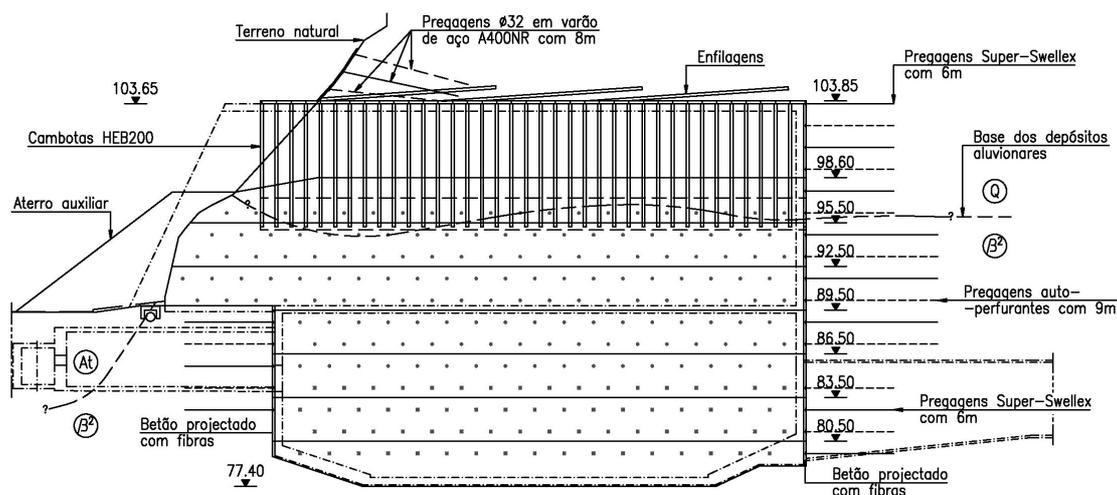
Faseamento executivo e sustimentos. Perfil ao eixo da estação elevatória
